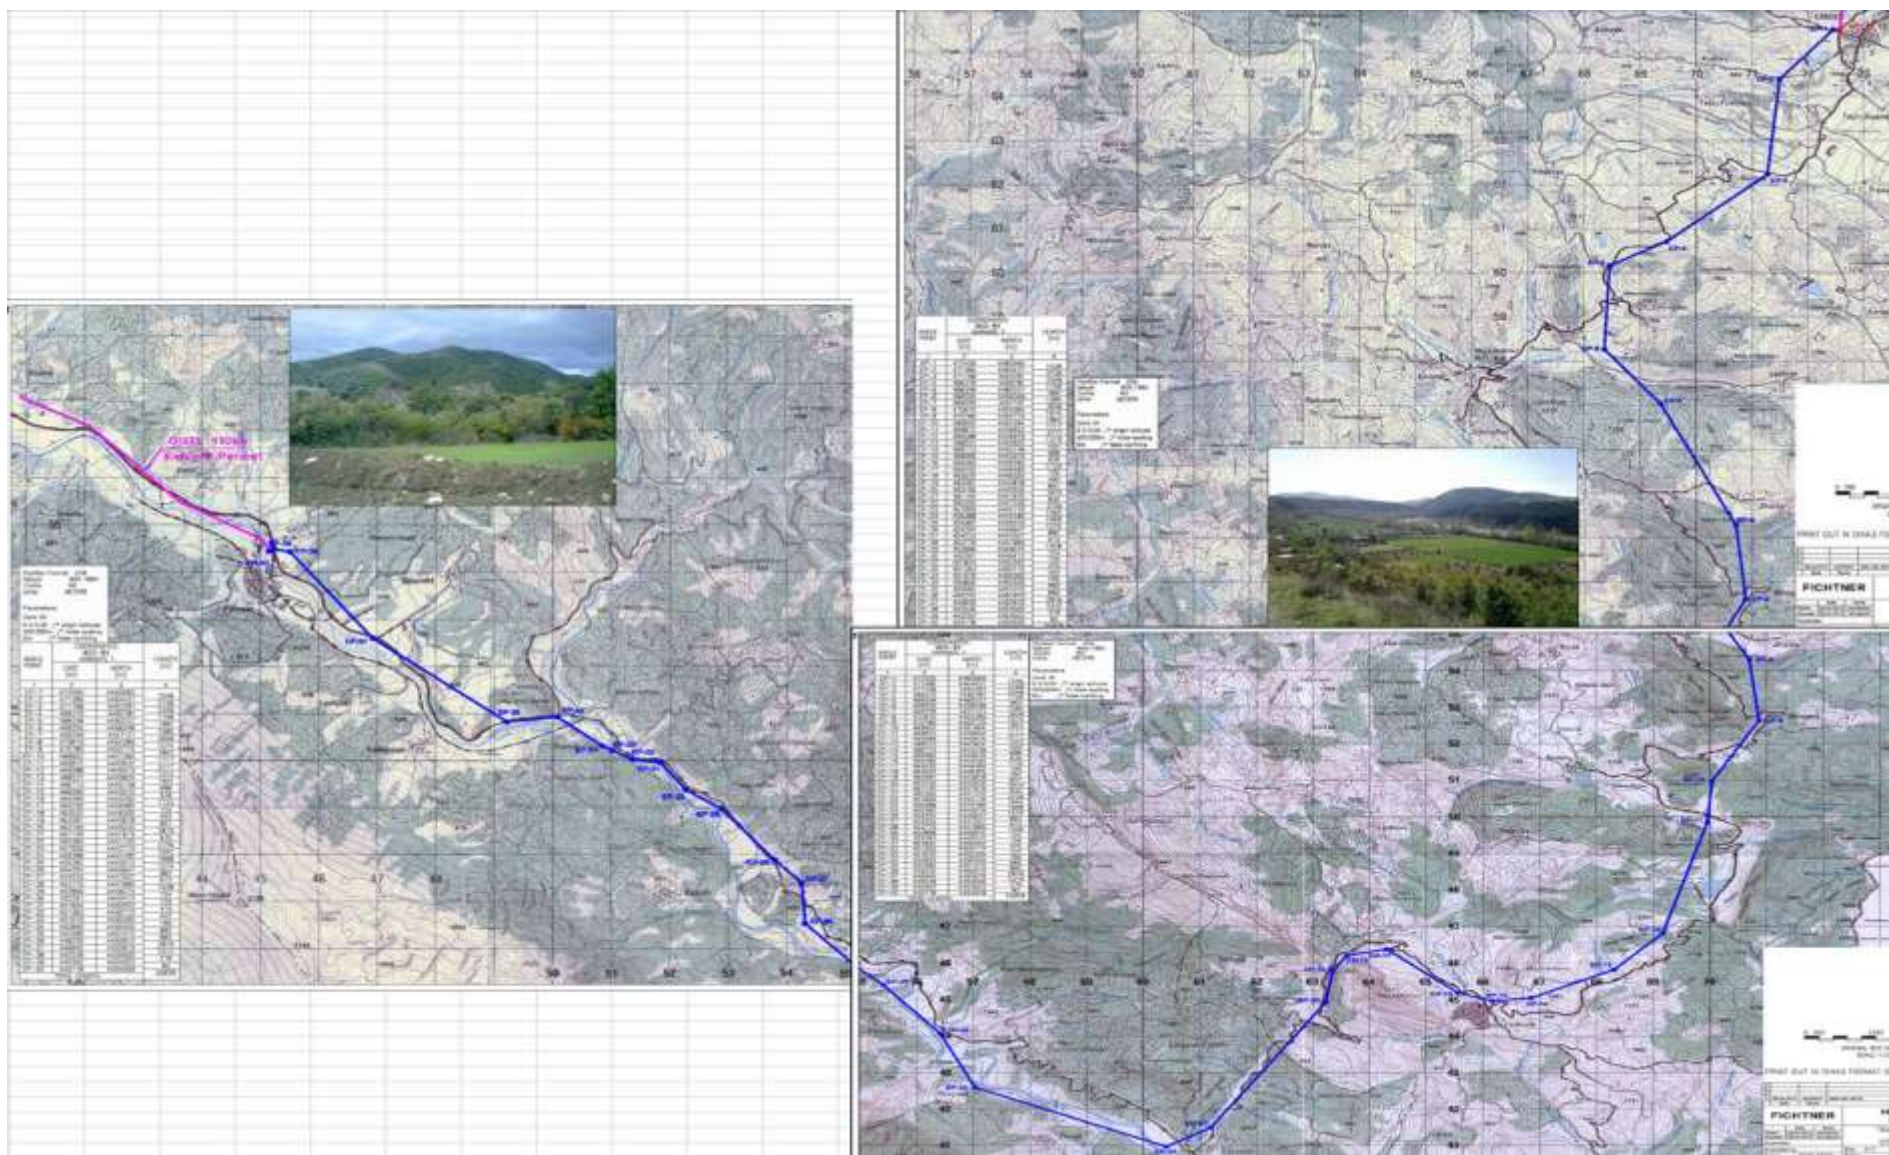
/1.: Planimetria e korridorit se linjes 110 kV Permet-Erseke
